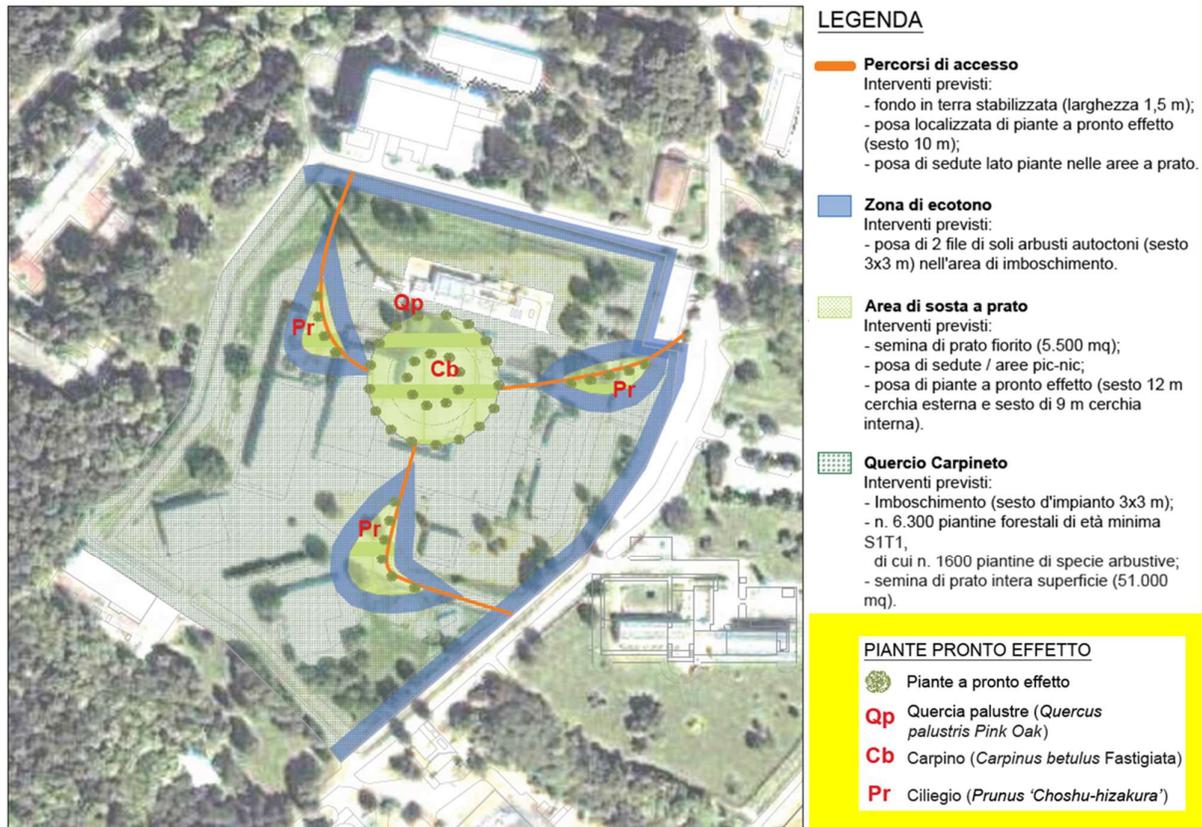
Planimetria degli interventi di piantumazione previsti per il Complesso INE (estratto da Tavola C1 – Progetto di Riqualificazione del Complesso INE)
